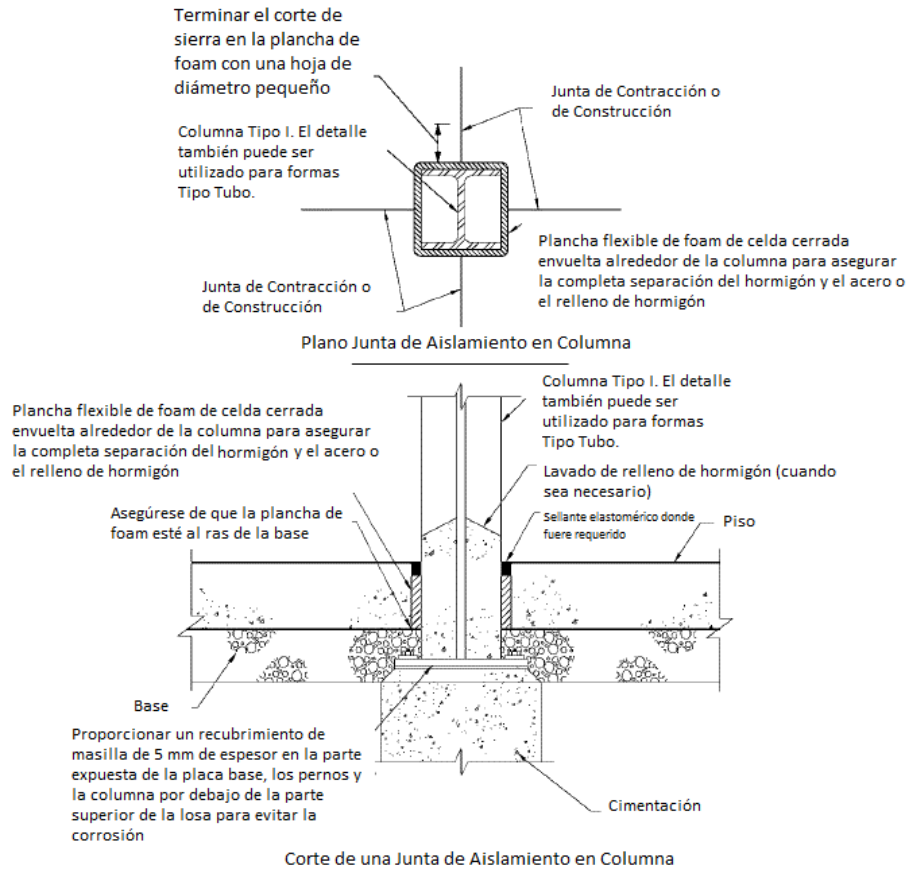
Junta en columna tipo I (ACI 360, 2016)
